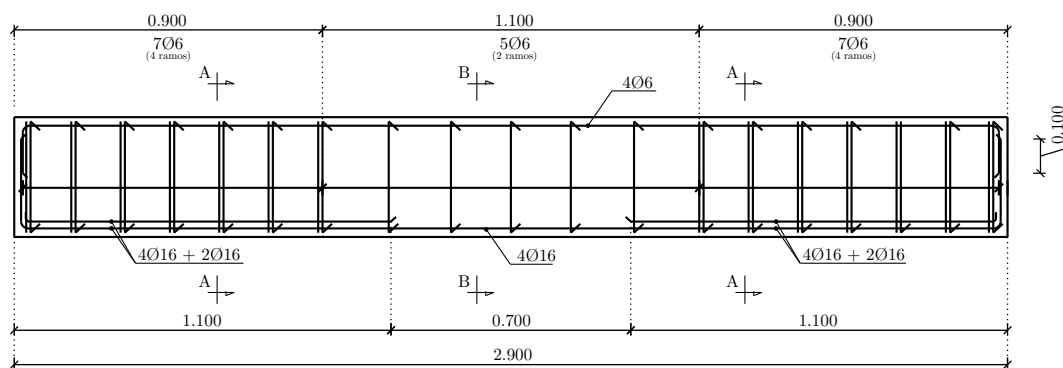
Geometria e disposição de armaduras nas duas vigas ensaiadas.
